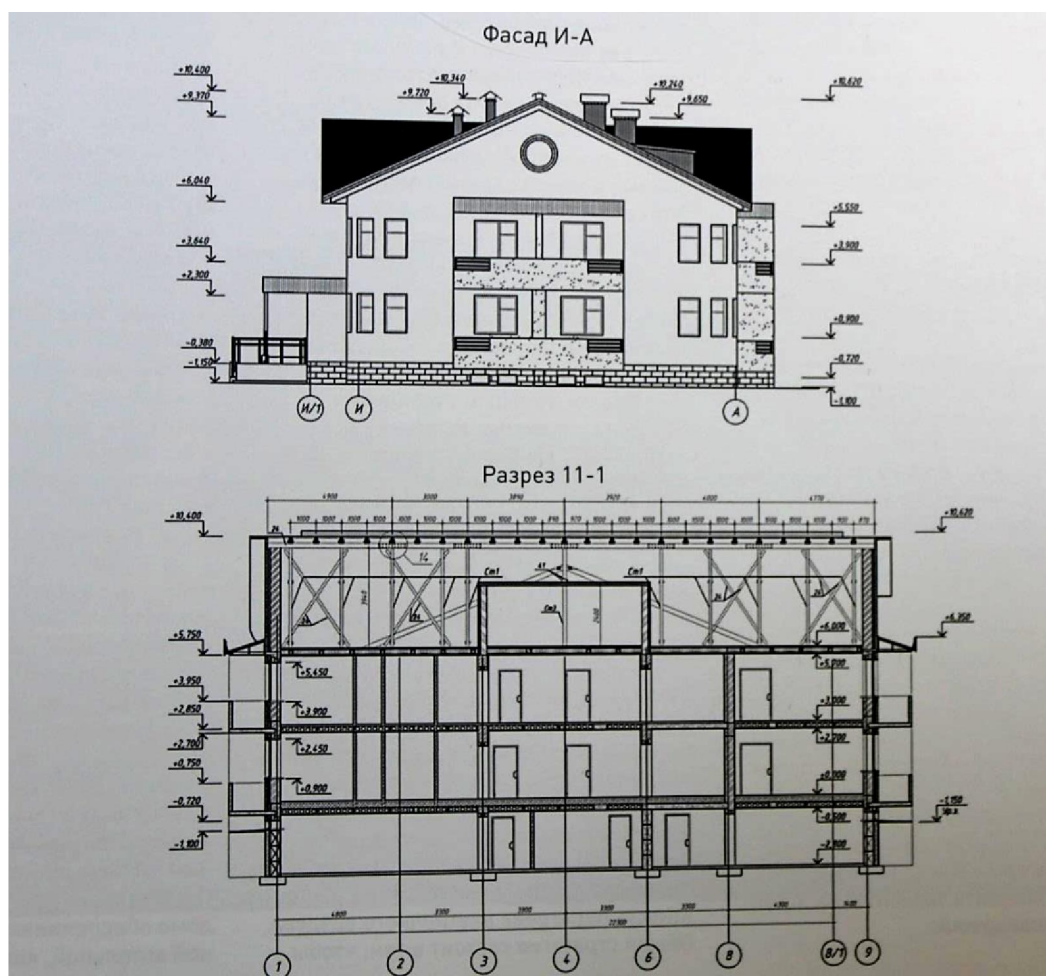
Фасад И-А и Разрез 11-1 12-квартирного двухэтажного дома
